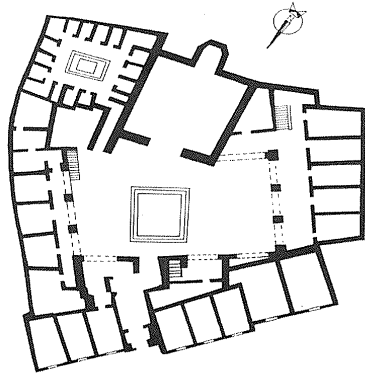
مسقط أفقي لمسجد رأس عين أزليتين بفاس القديمة.
